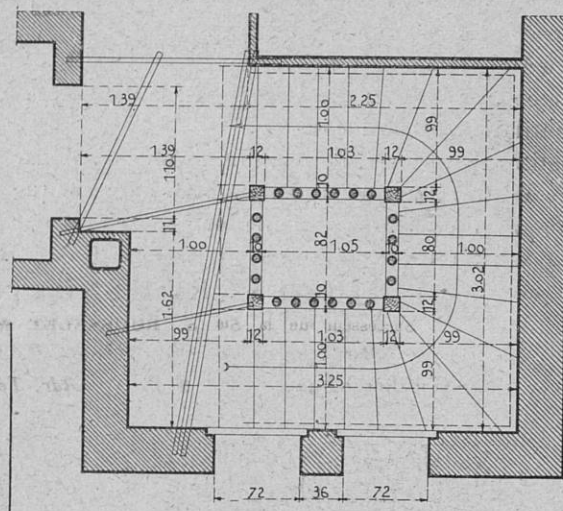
(éch. 0,015 p. m.). — Plan du premier étage.
